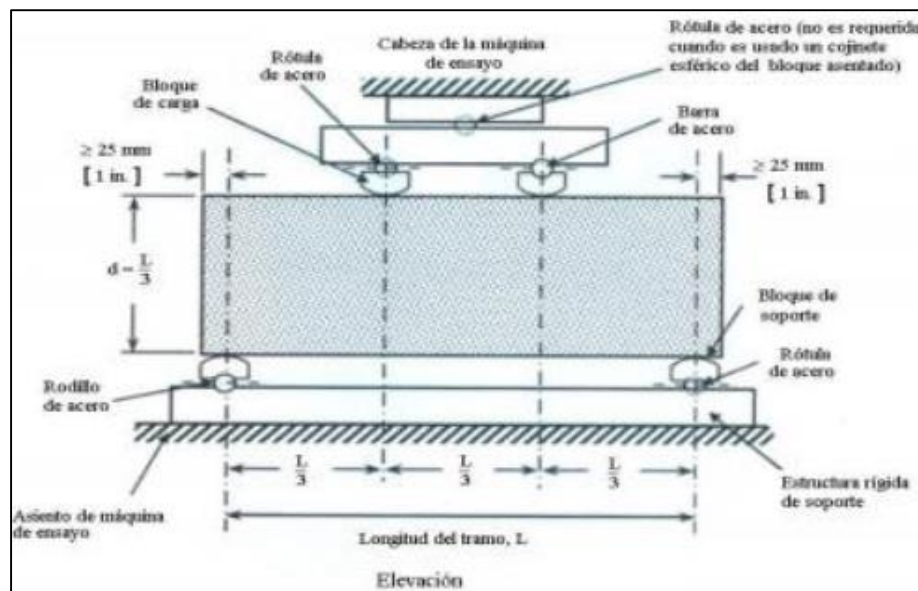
Vista del ensayo de rotura de vigas en el concreto.
